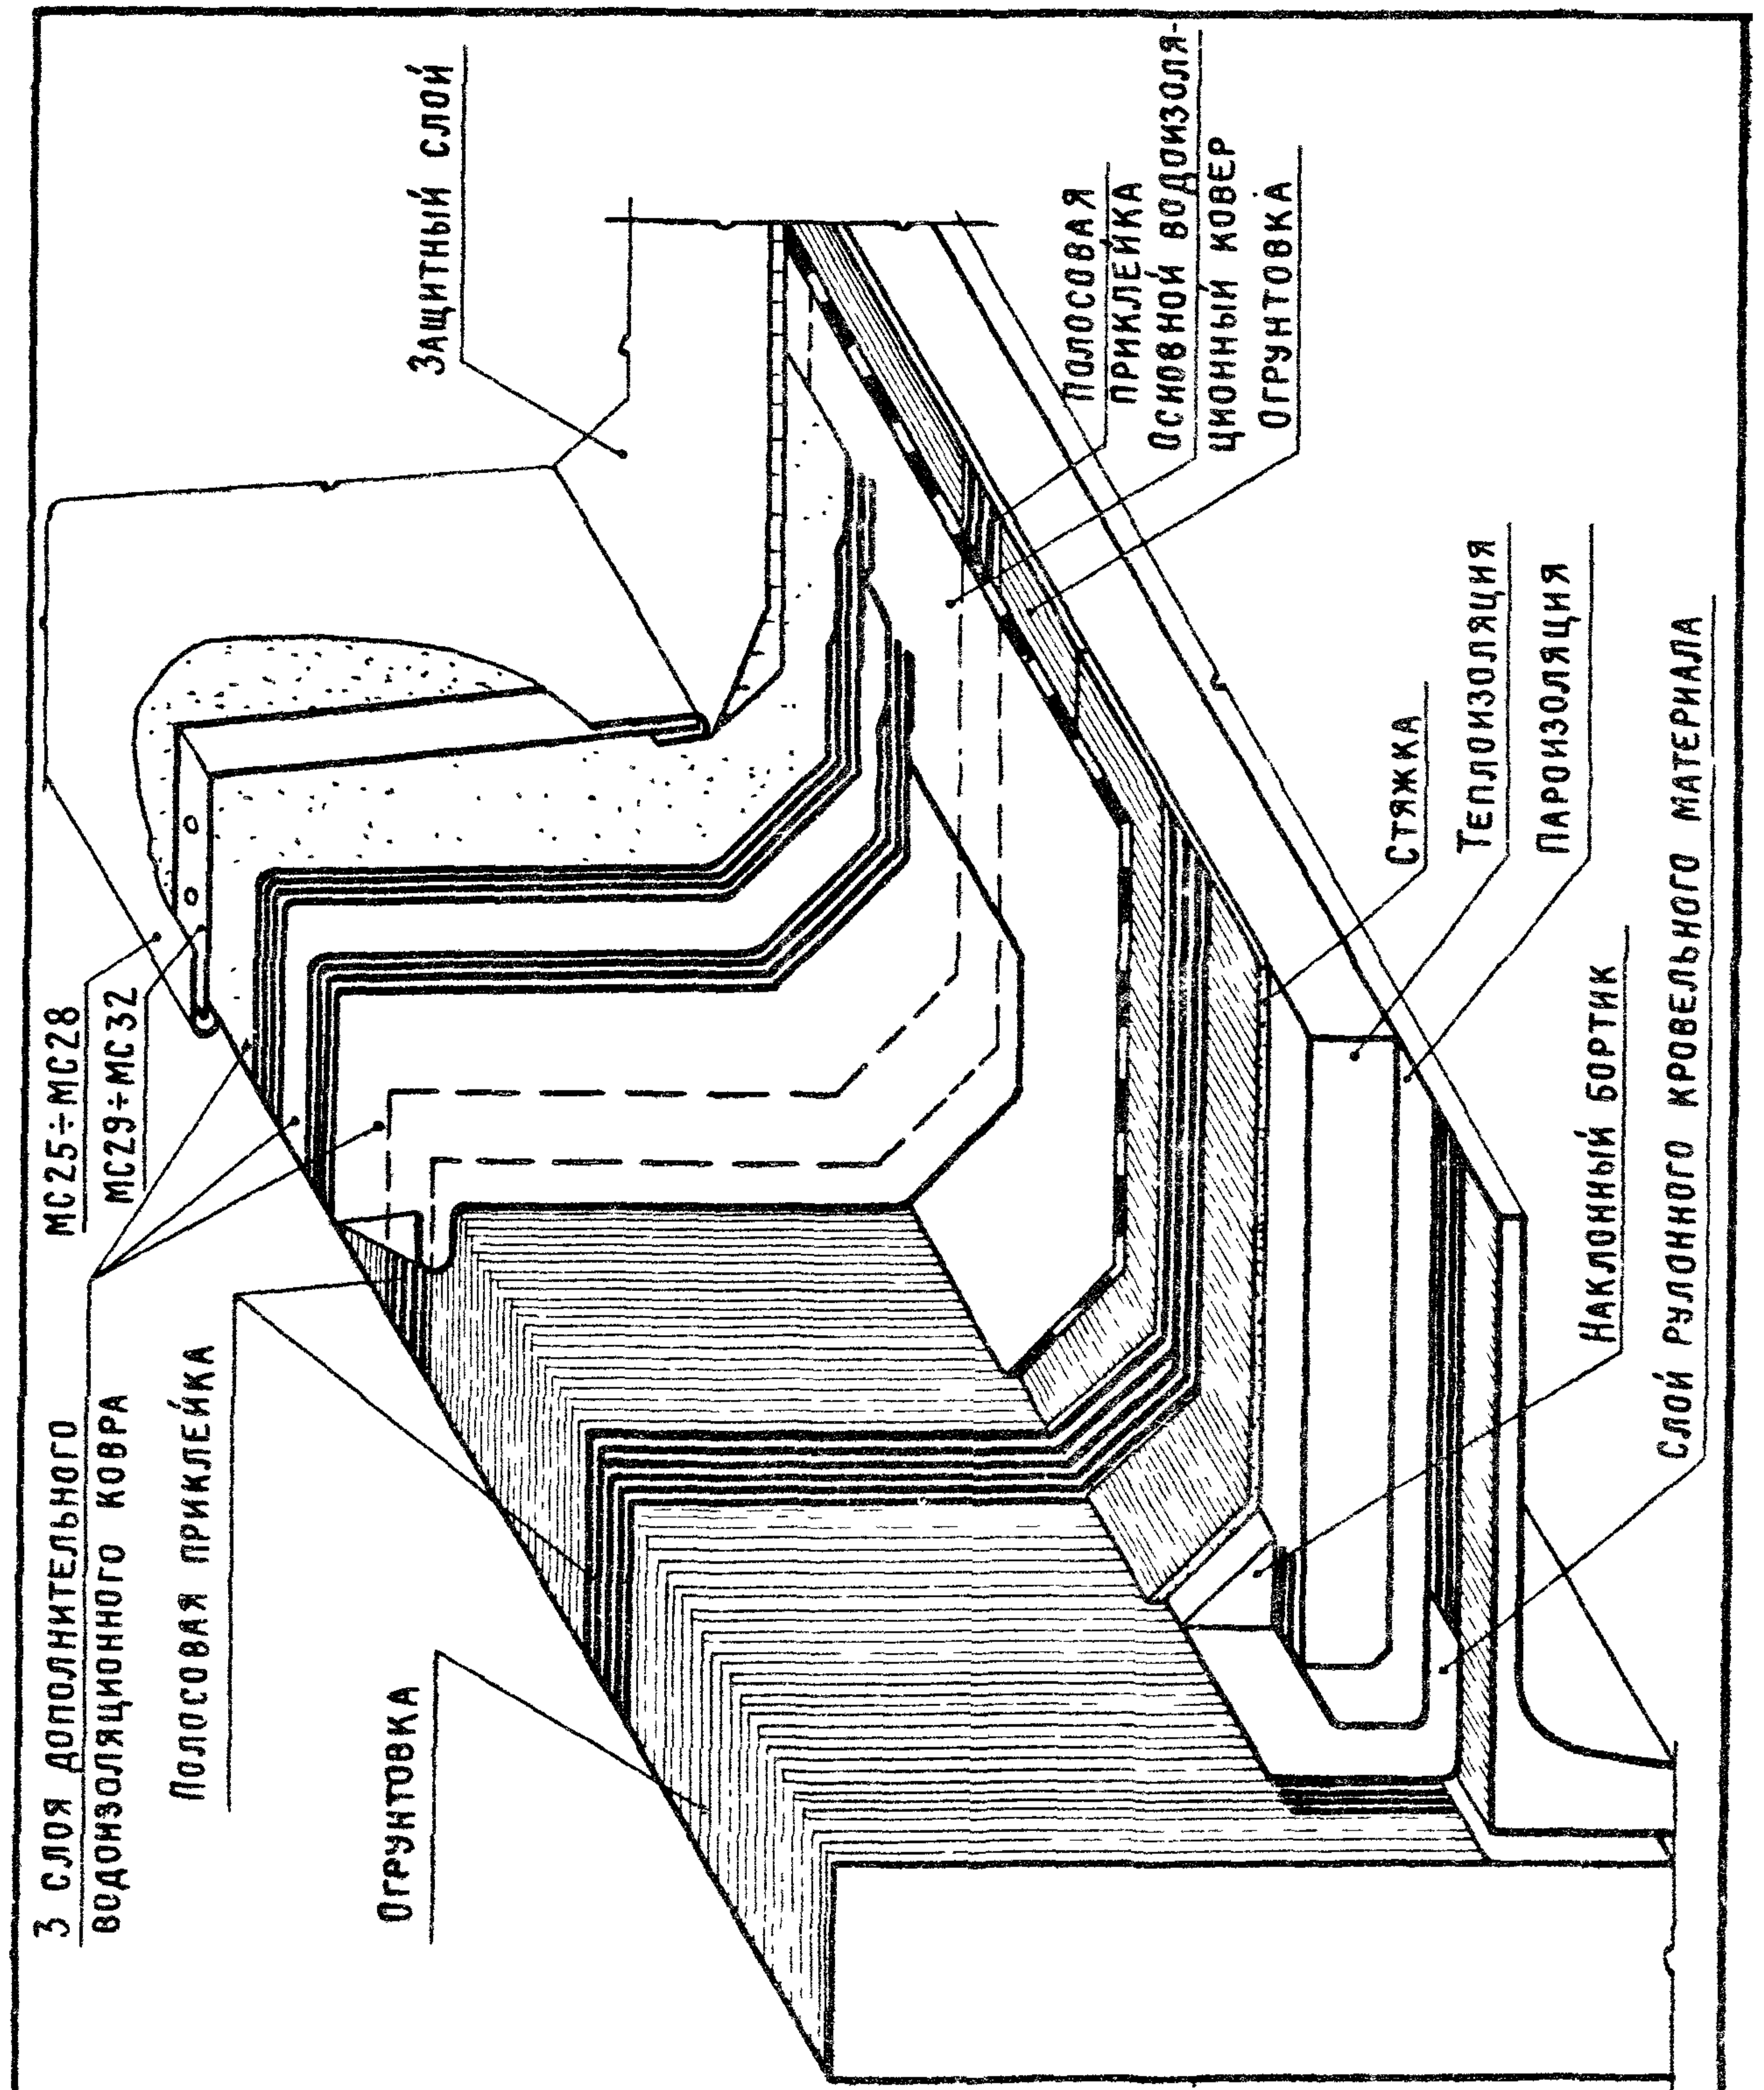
ПАРАПЕТ ВЫСОТОЙ 200÷450 ПРОДОЛЬНОЙ СТЕНЫ ПРИ УКЛОНЕ КРОВЛИ ДО 2,5% (с выходом водяных паров)
